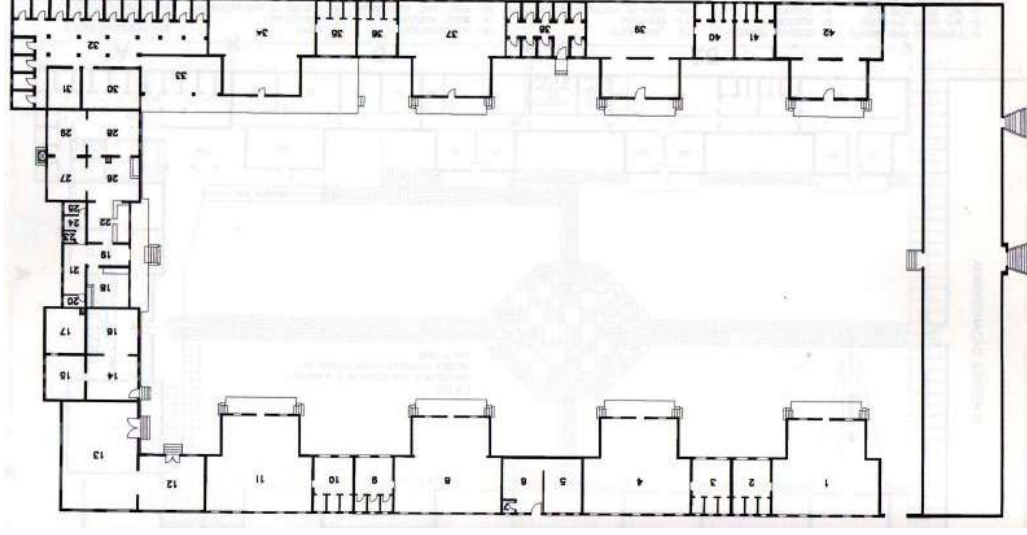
Planta do Presídio da Ilha Anchieta, 1998.
